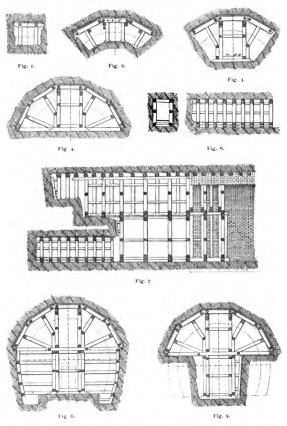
Bau des Semmering-Haupt-Tunnels. Fig. 1. Vorbruch. Fig. 2-6. Allmäbliche Erweiterung zum vollen Tunnelprofil. Fig. 7. Längenschnitt nach Fig. 5 und 6. Fig. 8. Längenschnitt des Stollens.
